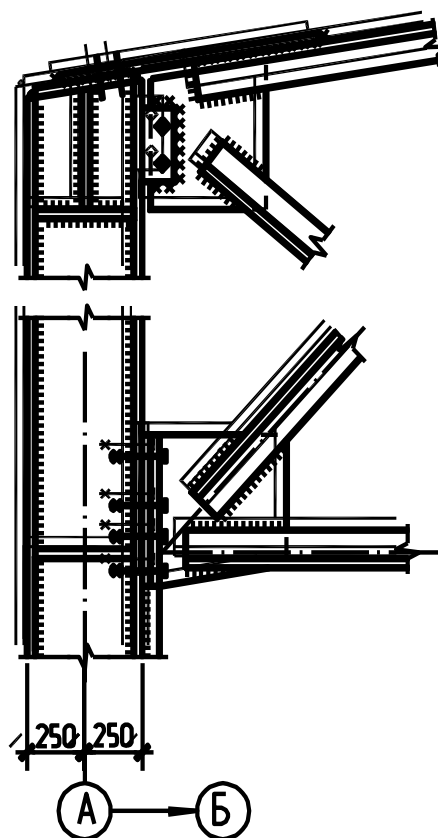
Жесткое сопряжение фермы с колонной
